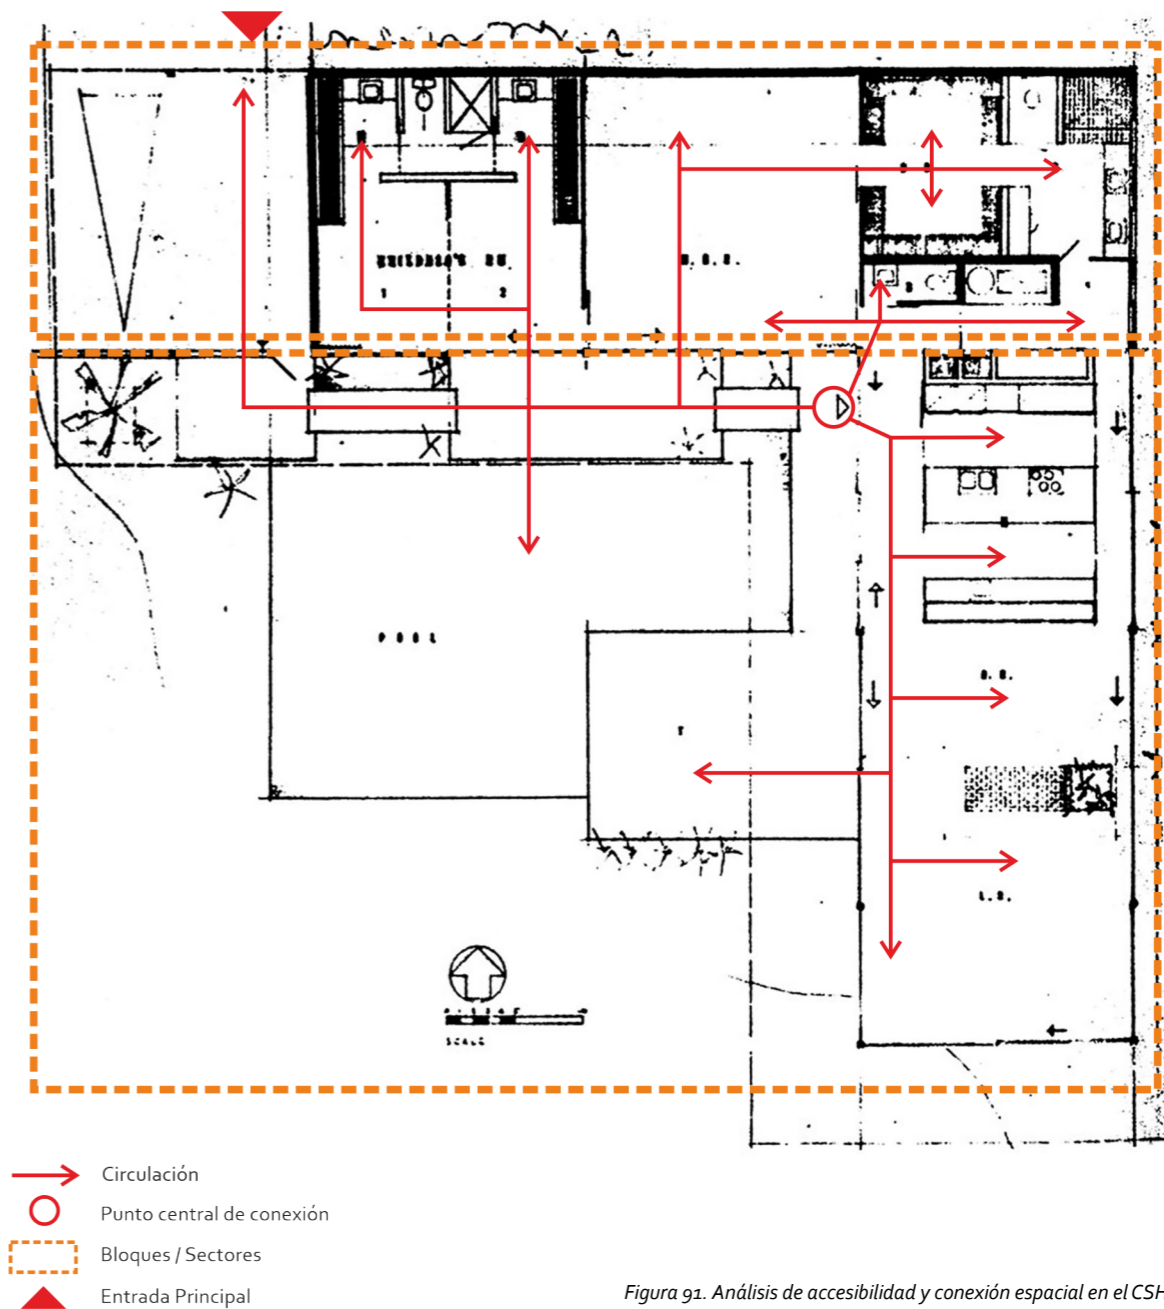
Análisis de accesibilidad y conexión espacial en el CSH 22 (Stahl House) 1960, sobre el plano original. Elaboración propia.
